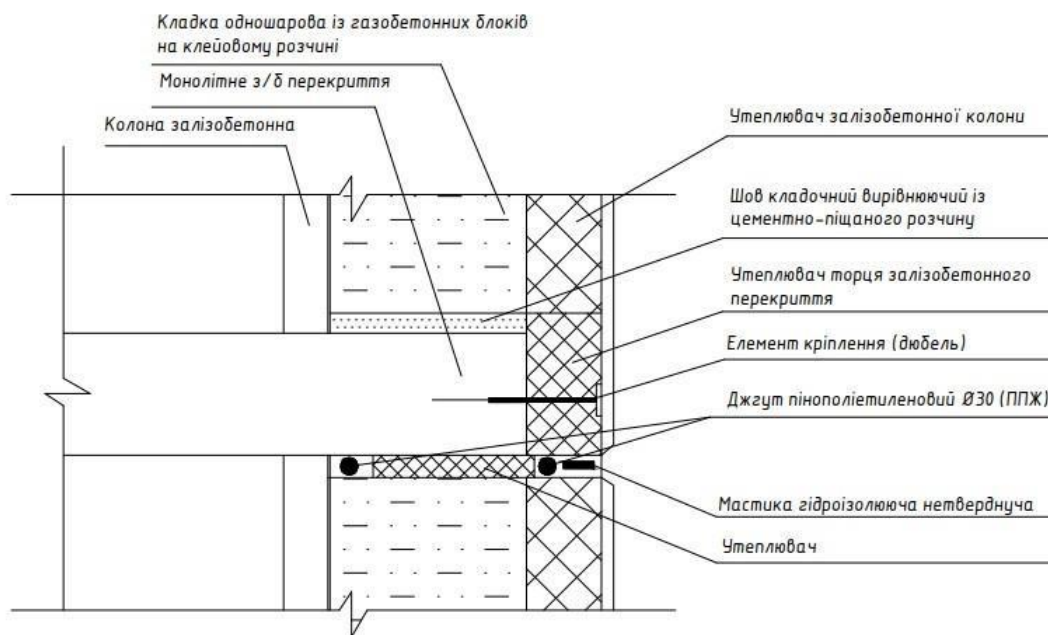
Конструктивне рішення влаштування вузла примикання стіни із газобетонних блоків до перекриття
